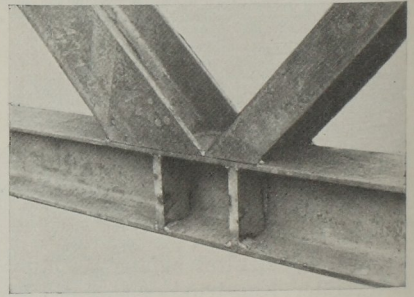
Knotenpunkt eines aus I Profilen geschweißten Trägers
